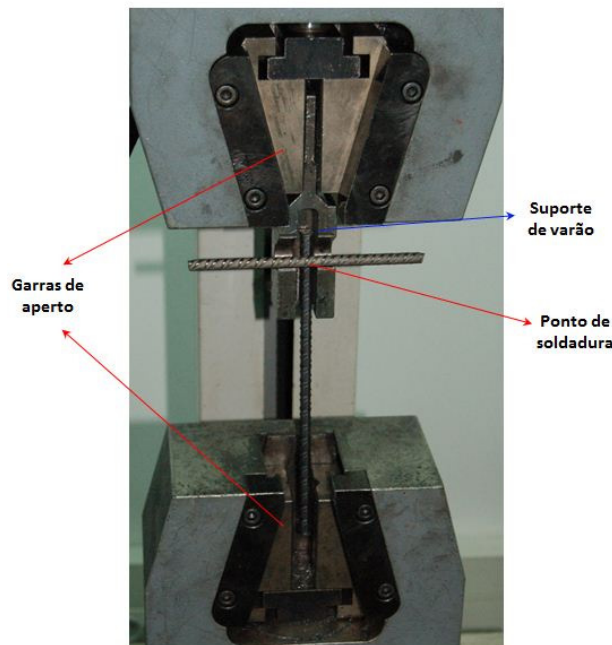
Provedor tipo 1 colocado no equipamento para ensaio de arranque de soldadura
